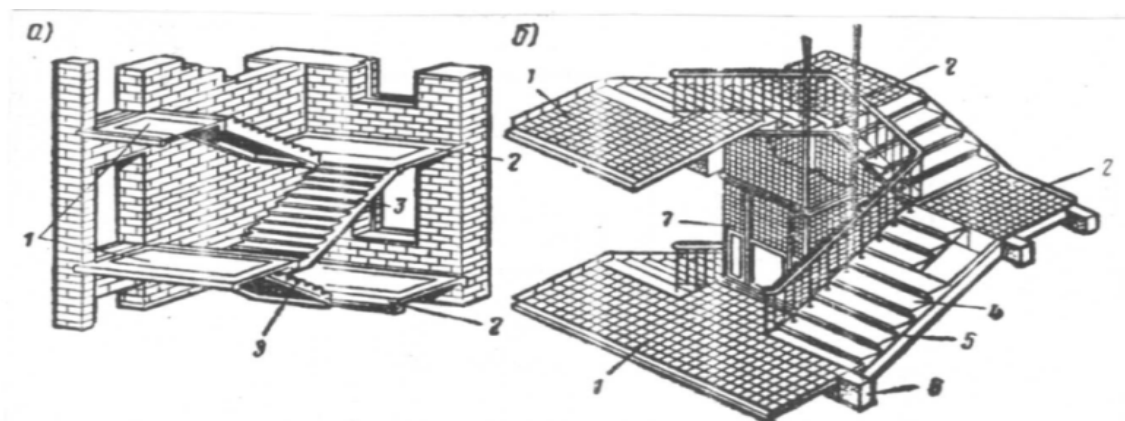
Общий вид лестниц: а – двумаршевая лестница; б – трехмаршевая лестница.
